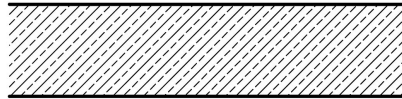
Klassische Stahlbetonvollplattendecke [36]
